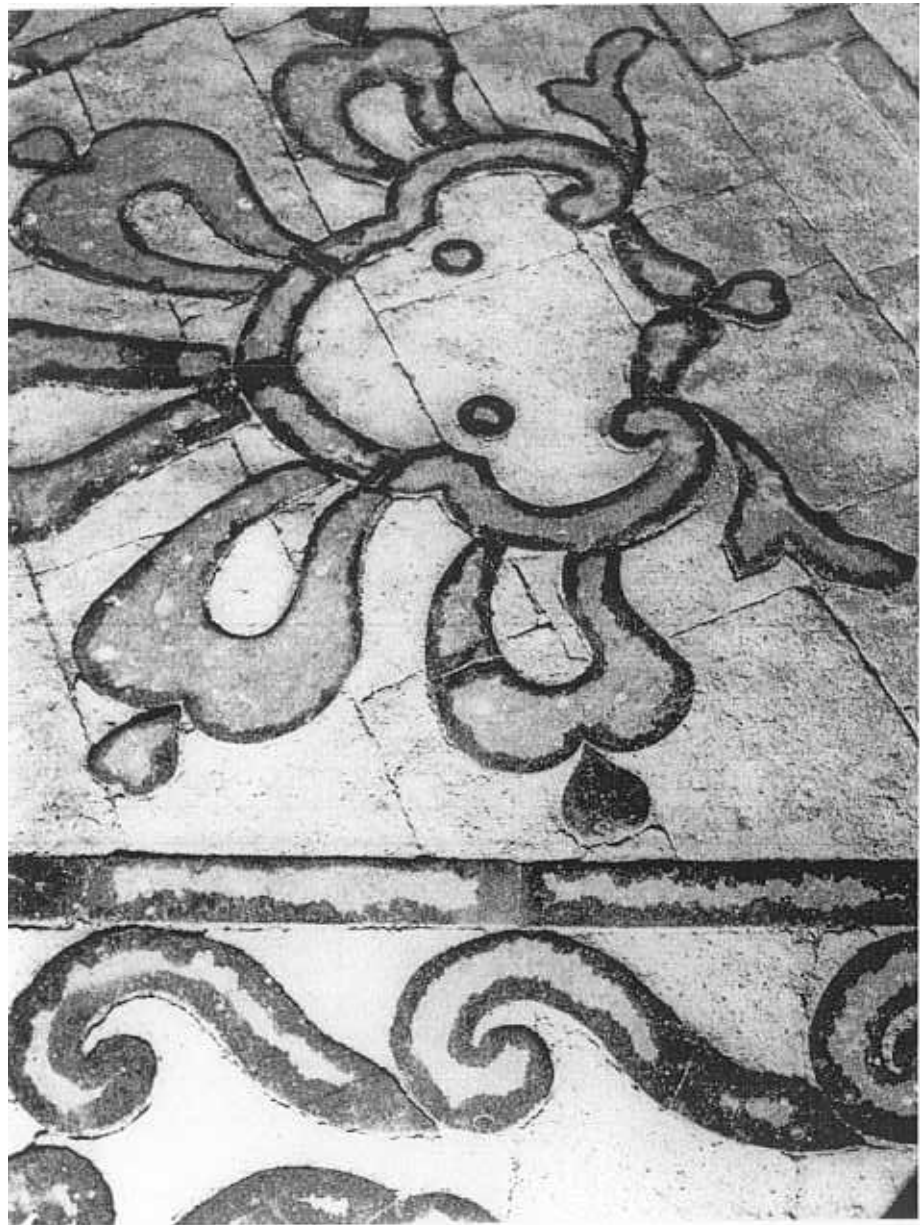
Siracusa. Chiesa di San Filippo Neri. Particolare del pavimento prima del restauro. Si osservano le profonde abrasioni del fondo e l'efflorescenza dell'umidità dal sottosuolo.
